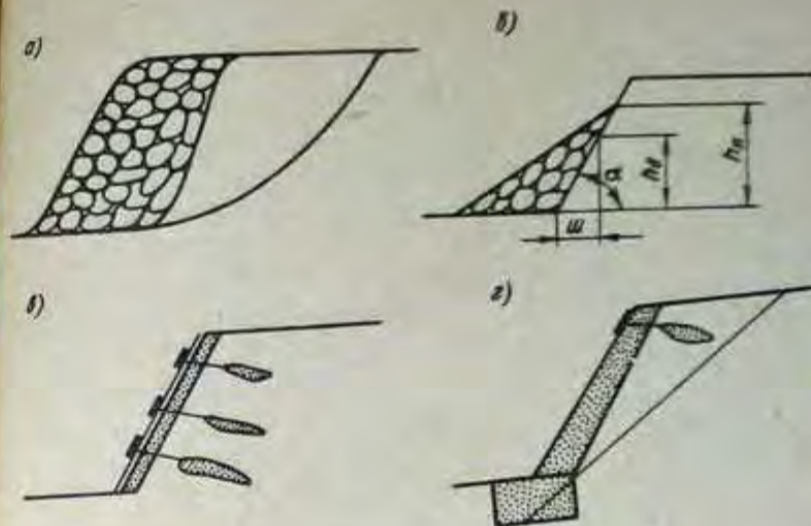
Типы поддерживающих сооружений: а — контрфорсы; б — контрбанкет; в — защитная железобетонная стенка; г — подпорная железобетонная стенка
